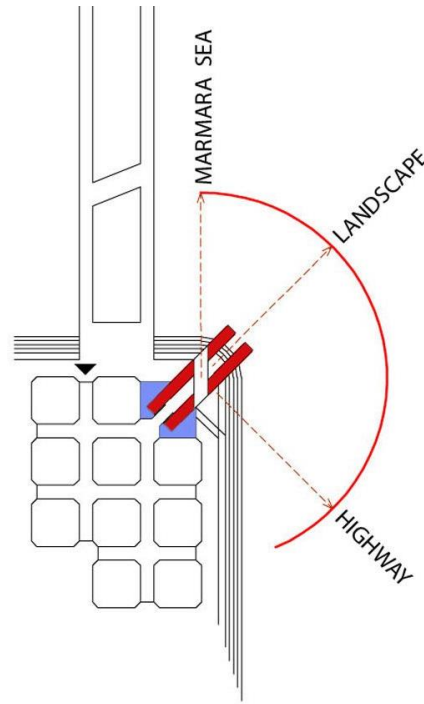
Mc Aslan’ın Bankacılık Üssü Planı ve Boş Bırakılan Köşeler [81]
